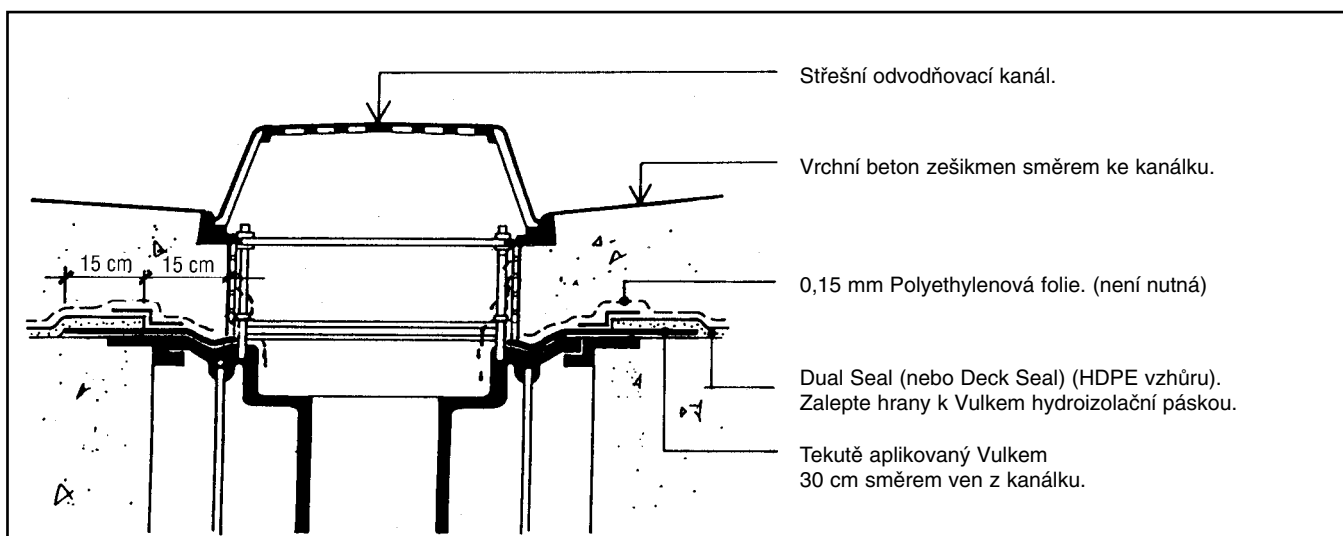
Průnik. (Použití tekutě aplikovaného Vulkemu)
